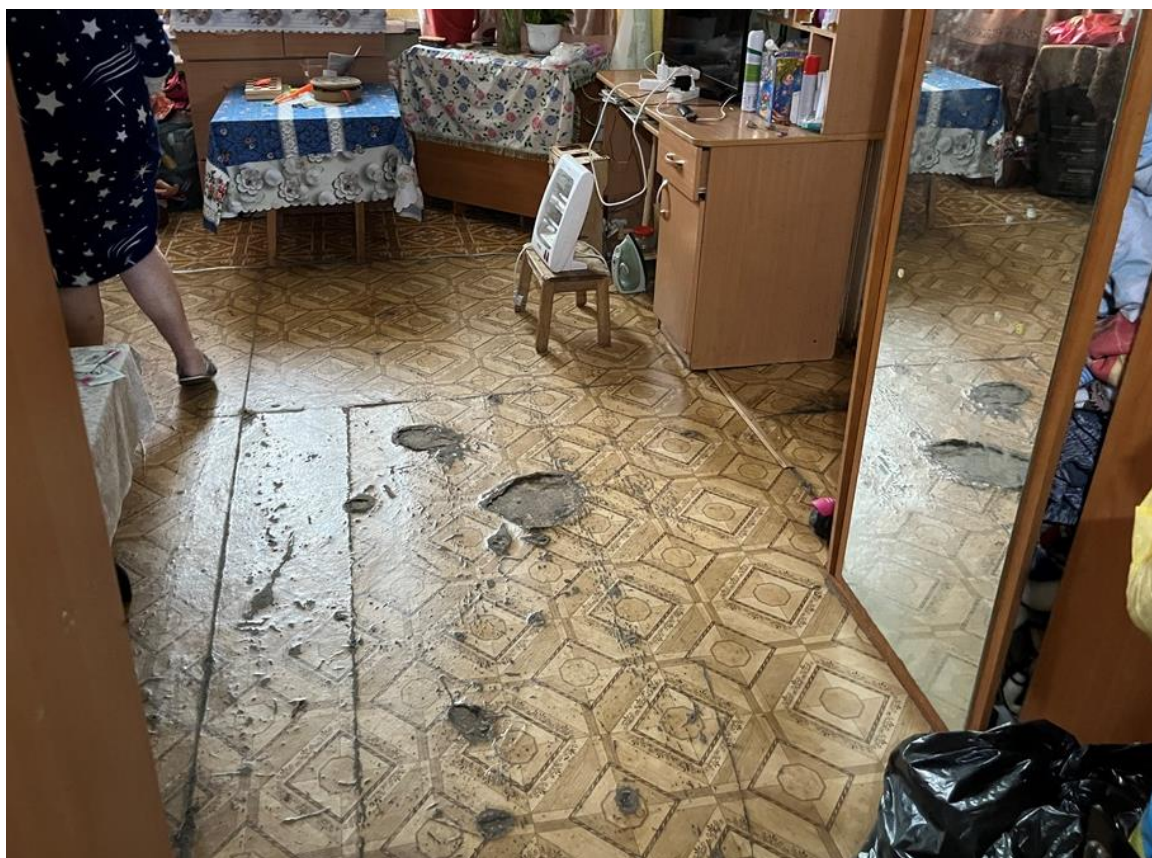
Прогиб перекрытия, в осях В-Г/1-2 2 этаж
